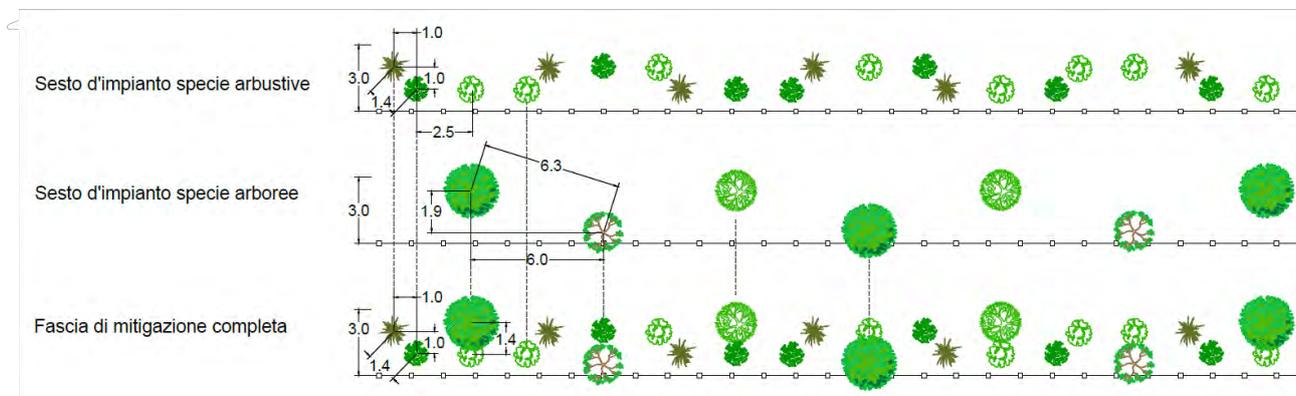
Dettaglio tipologico Fascia di mitigazione A – planimetria
